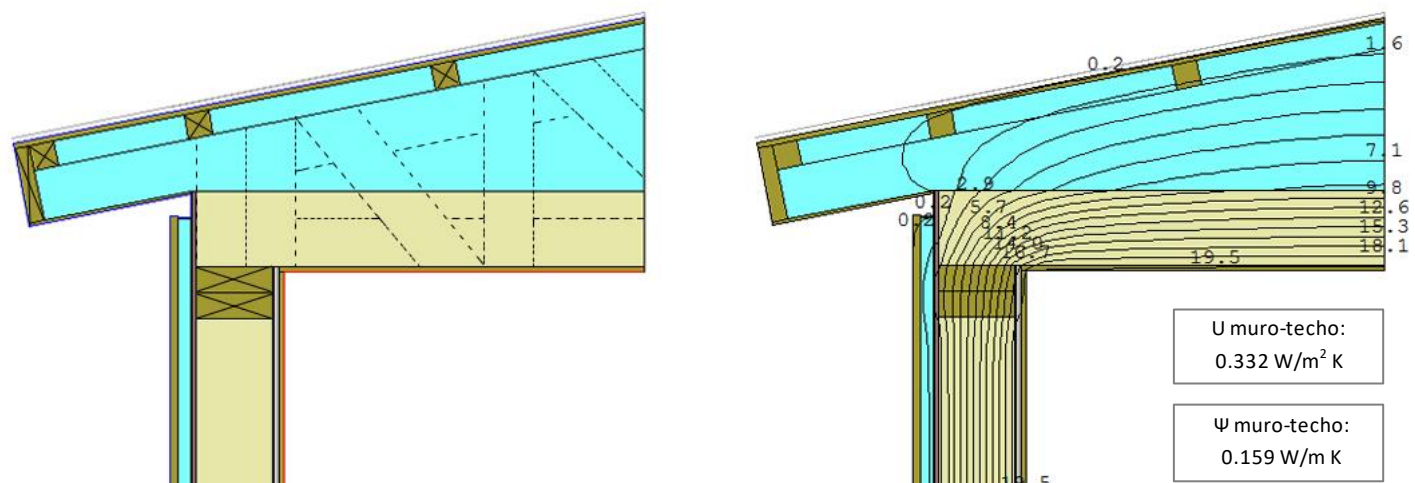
Detalle y diagrama de isotermas unión muro-techo, en vista de corte utilizando tabiquería de 2"X6"
